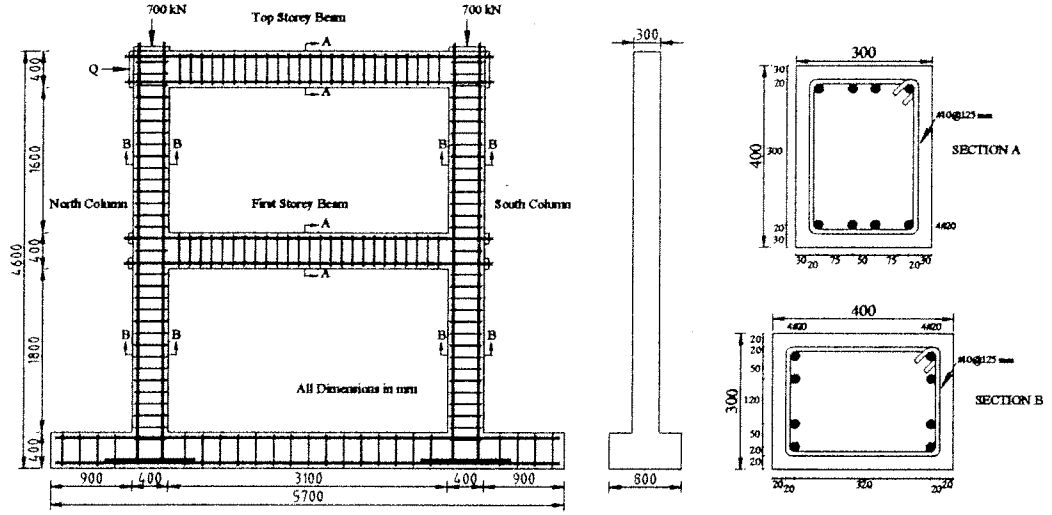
Betonarme arayüz elemanı test çalışmasında kullanılan betonarme çerçeve[7]
